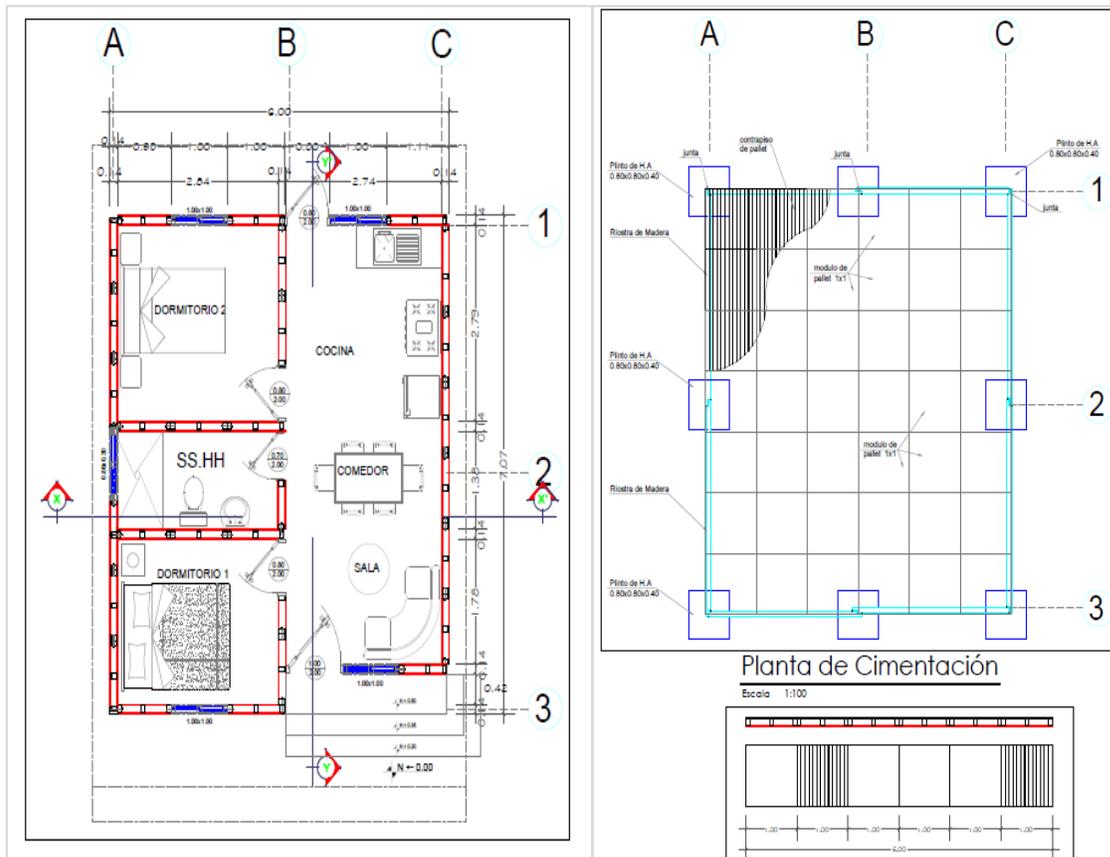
Planta arquitectónica y planta de cimentación con paneles tipo sándwich
